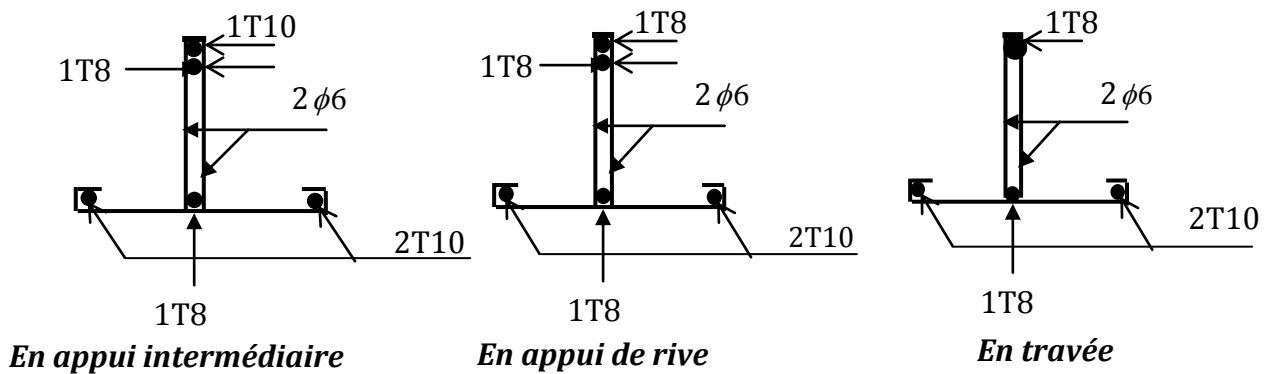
Schémas de Ferrailage des Poutrelles de la terrasse accessible
